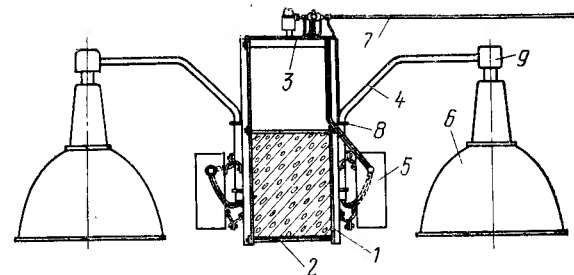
Крепление светильников и осветительной сети, выполненной проводами на изоляторах, к нижнему поясу железобетонной фермы.
